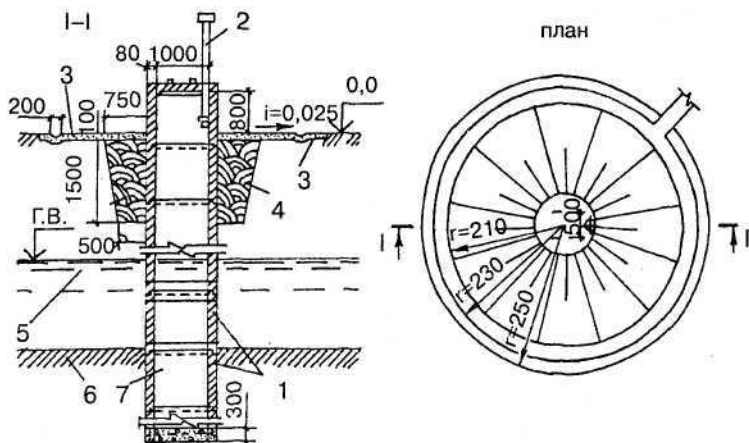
Конструкция шахтного колодца из сборных железобетонных колец: 1 — кольца; 2 — вентиляционная труба; 3 — щебеночное крепление; 4 — глиняный замок; 5 — водоносный грунт; 6 — водоупорный грунт; 7 — зумпф
